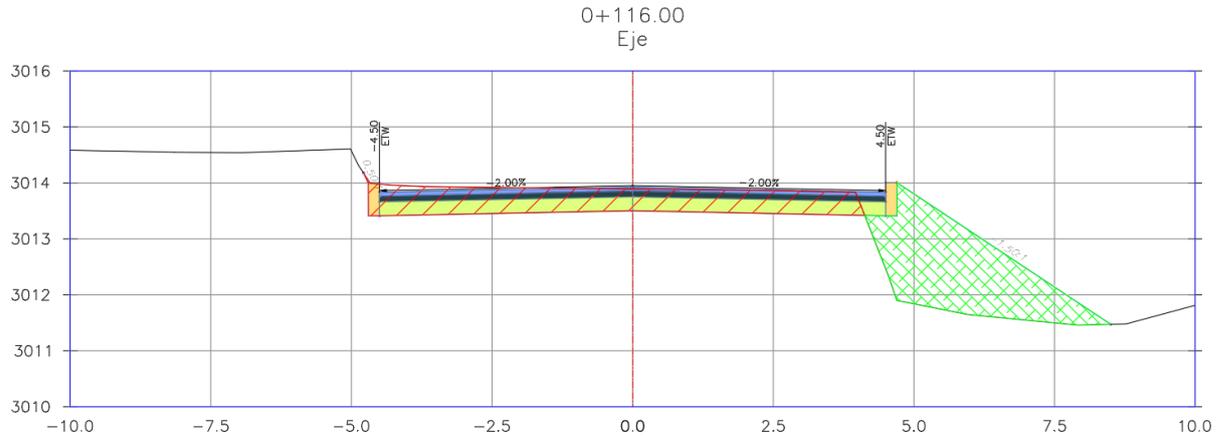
"PROPUESTA ANCHO DE CALZADA 7M, (EJE TRAZADO VIAL APROBADO)."
